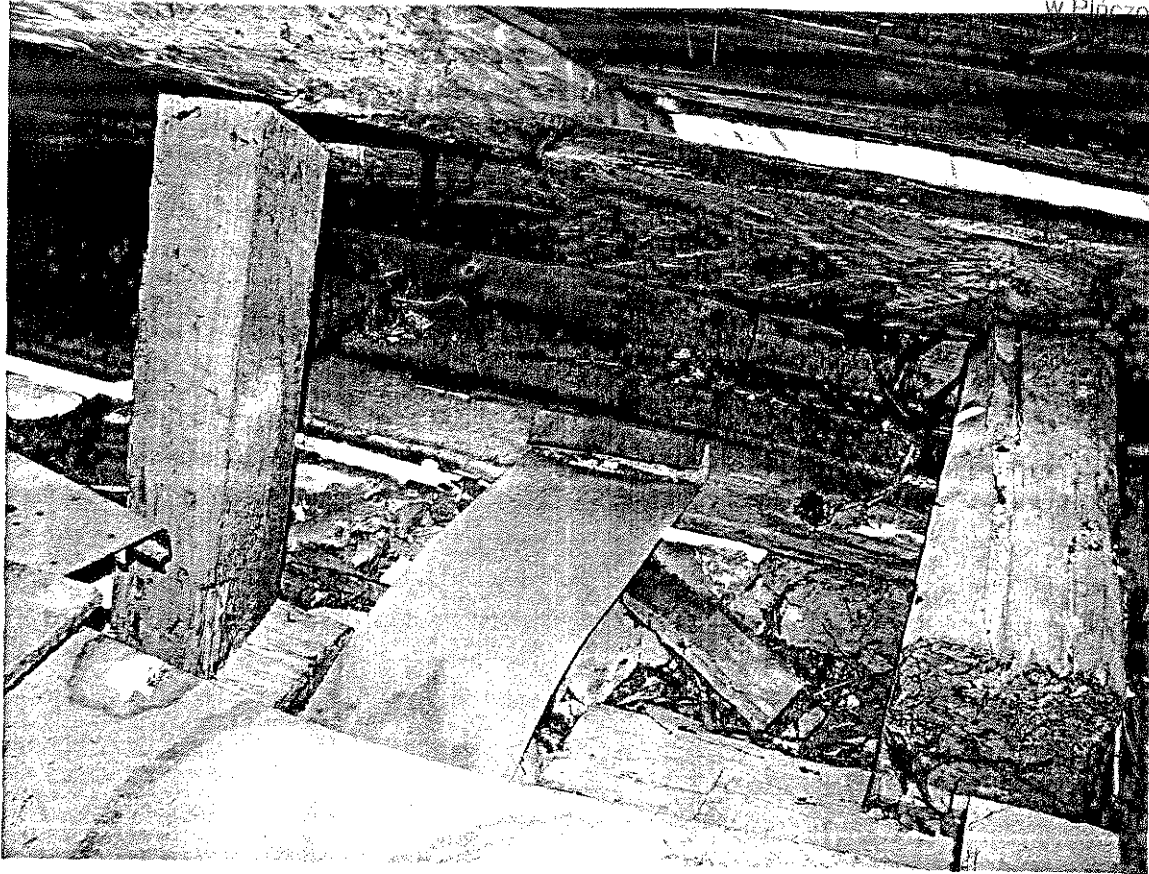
Istniejąca więźba dachowa – widok poprzeczny.
